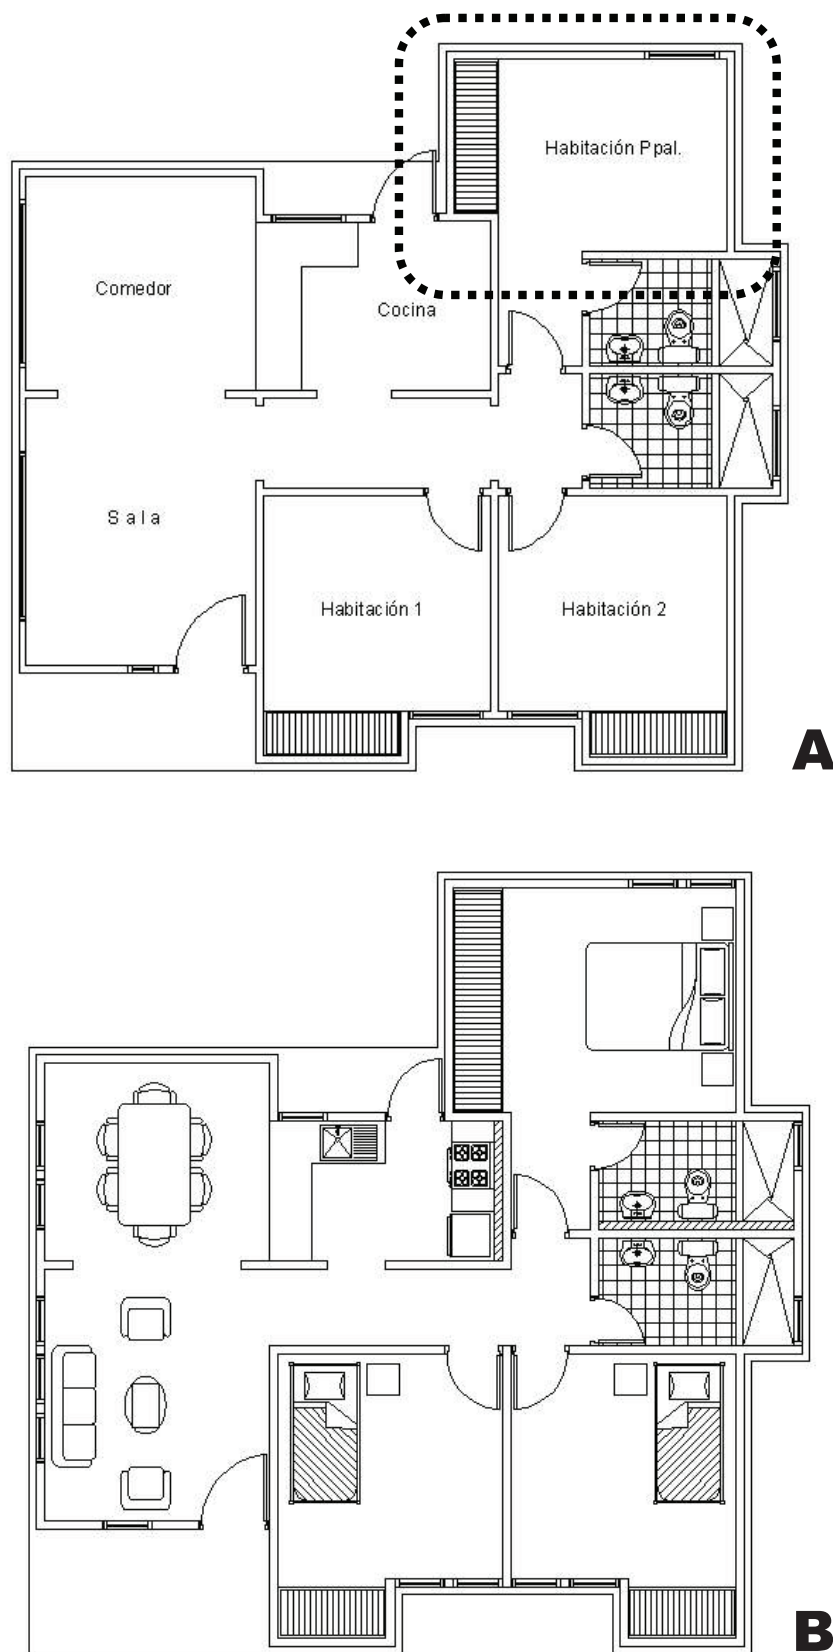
(A) Planta original del Modelo 1 Vivienda Aislada tipo rural (86,20 m²) de CVG Proforca. (B) Planta rediseñada por los autores.
